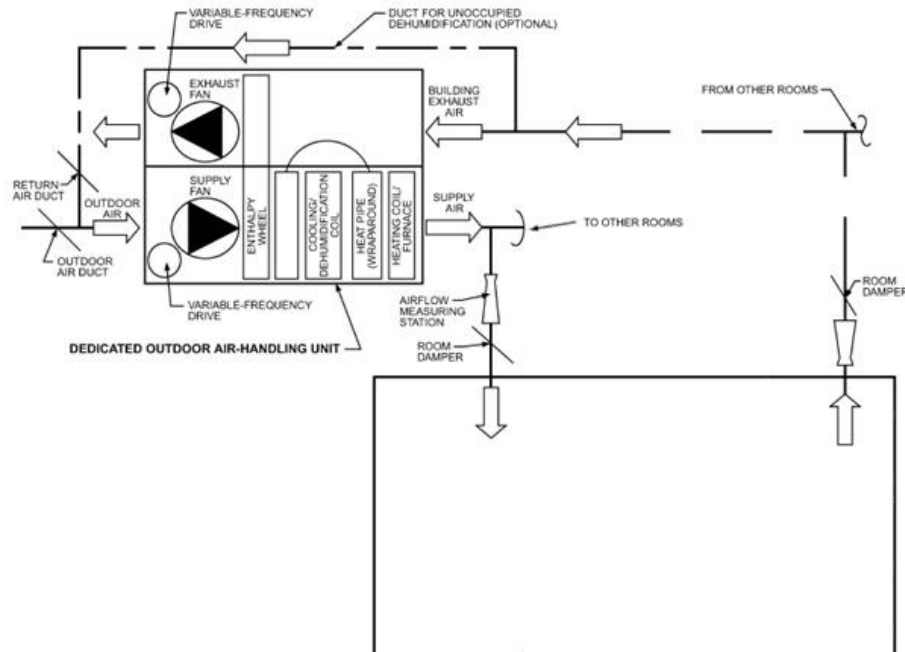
Tipico layout di un impianto a Tutt'Aria ( fonte ASHRAE )
